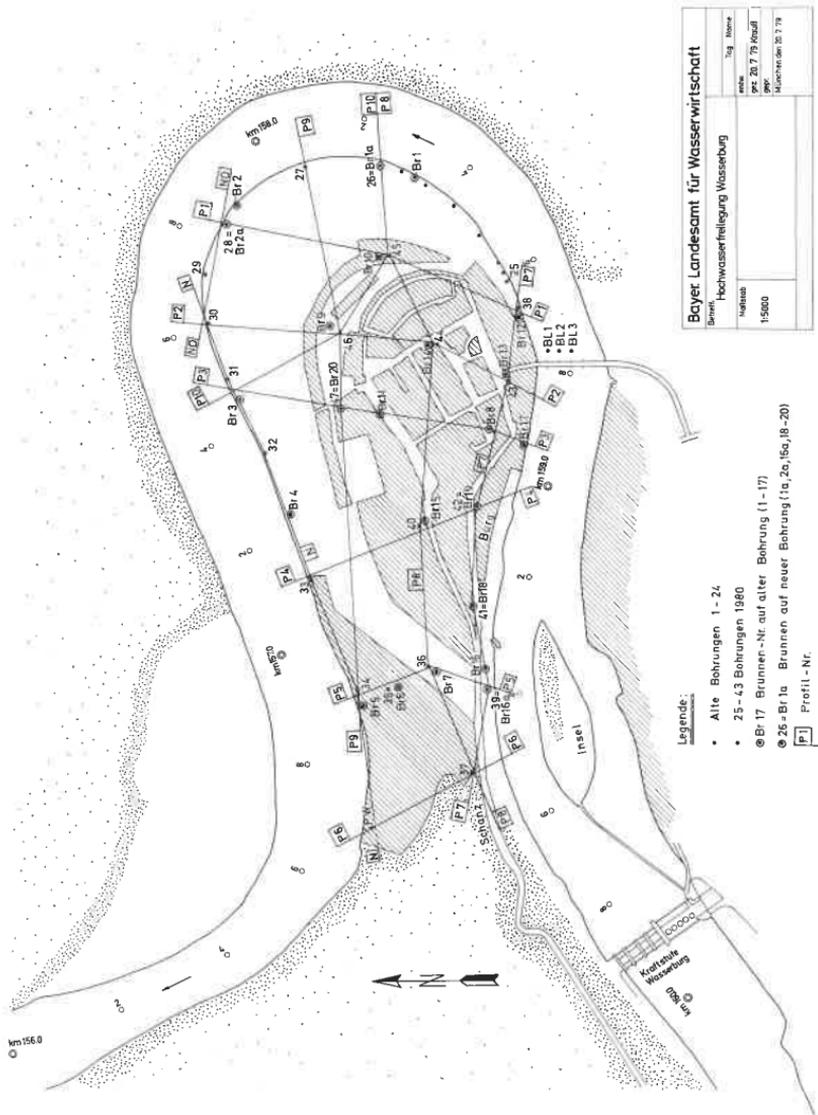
Übersichtslageplan mit Bohrungen, GwBeobachtungsbrunnen und Lage der Profile.
